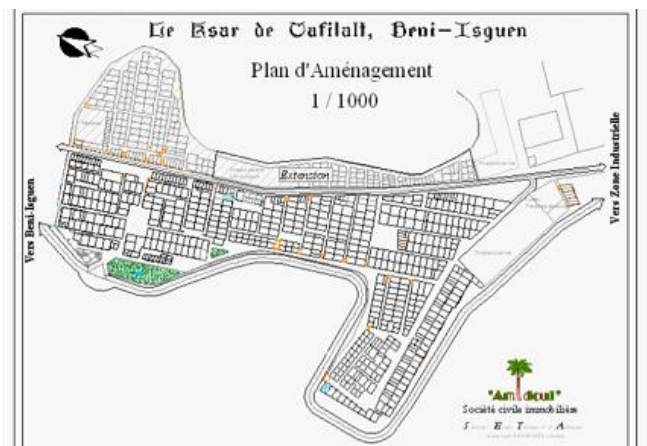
Plan d'aménagement du ksar de Tafilelt
